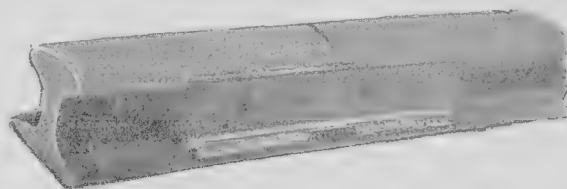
Стык с приваренными накладками (электрическая сварка).
